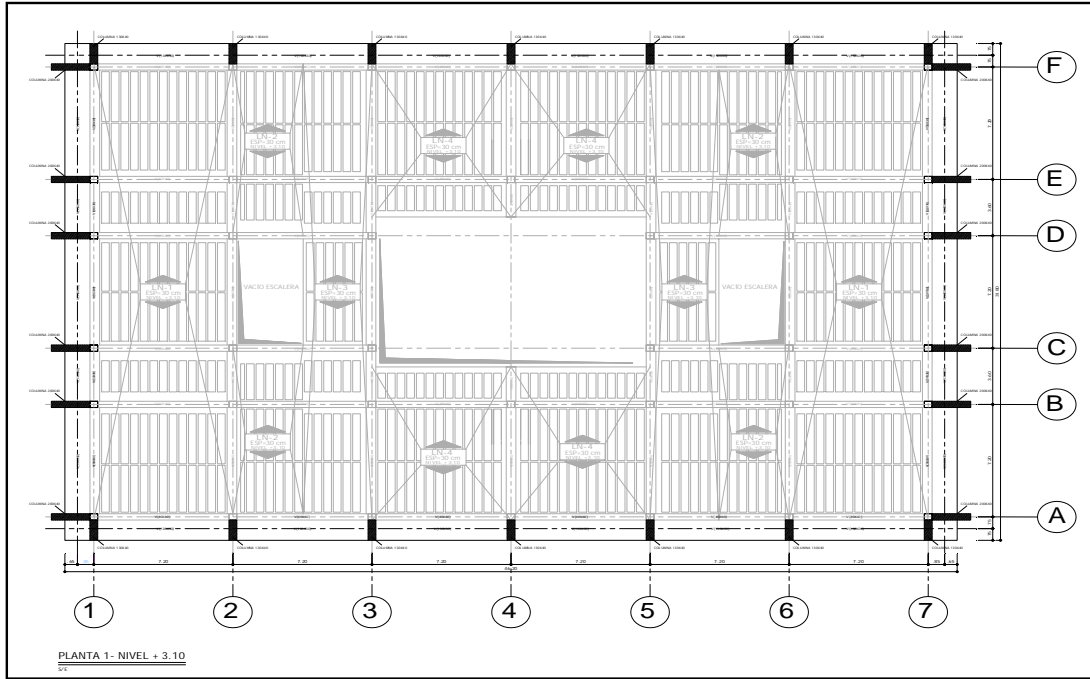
Planta tipo del modelo de refuerzo de muros en voladizo.
